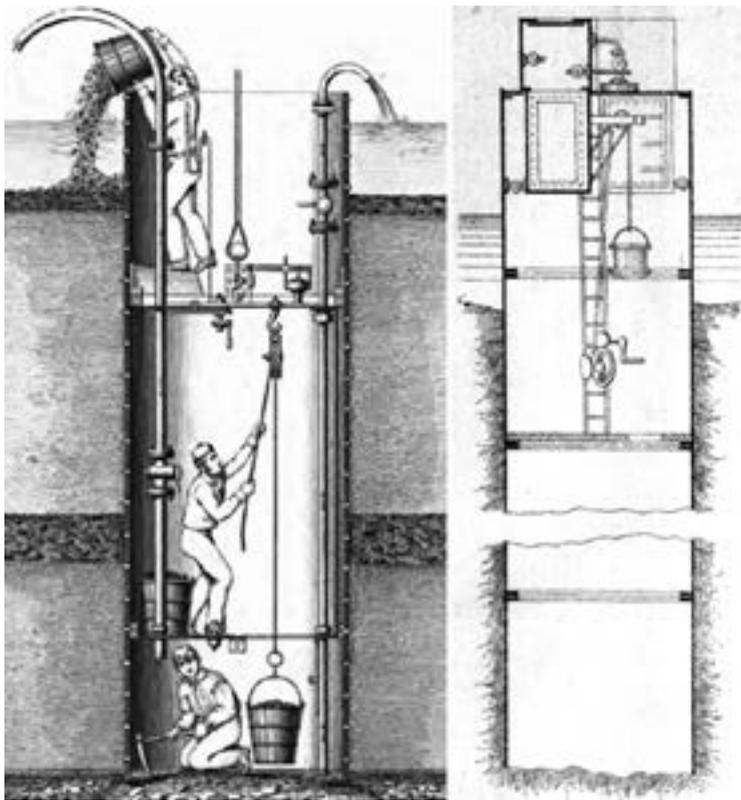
| Tubo di lamiera di ferro progettato da Jacques Triger per estrarre
